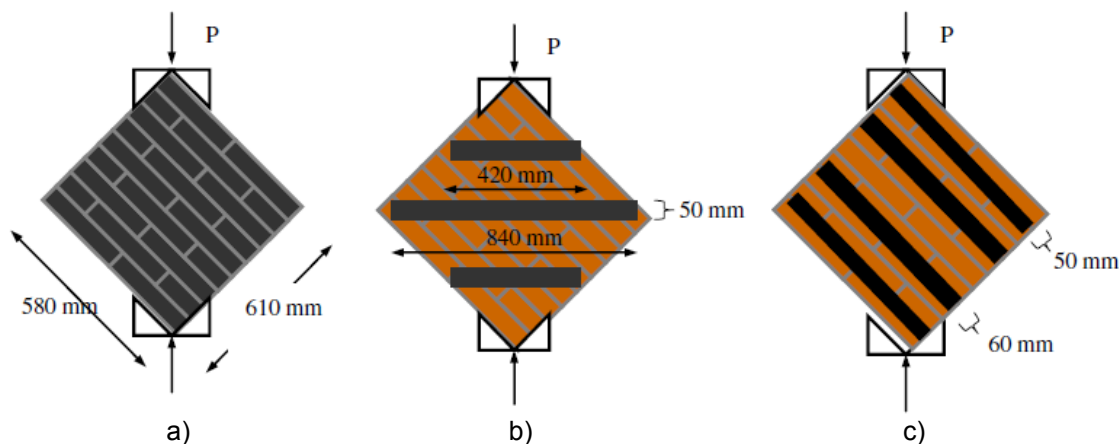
Configuraciones de refuerzo del ensayo de tracción diagonal.
